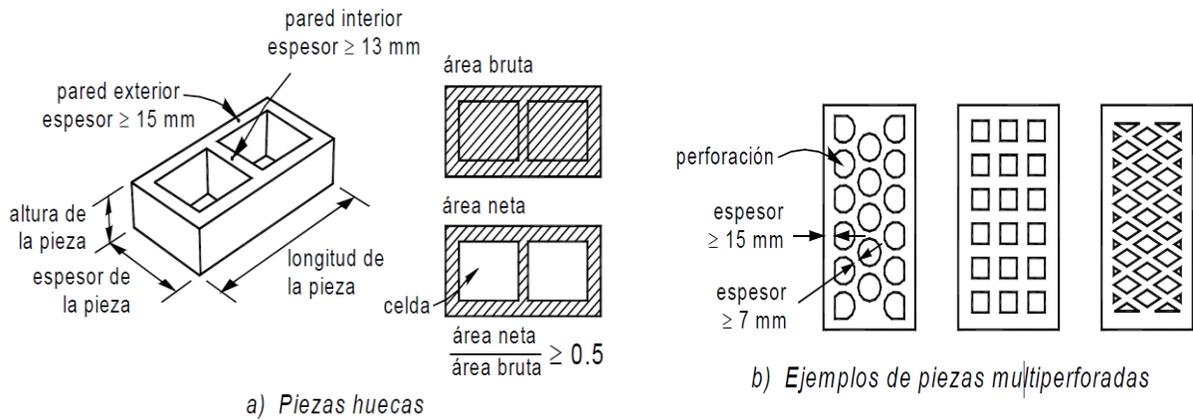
8 Piezas huecas utilizadas en mampostería reforzada interiormente (NTC, 2017)
